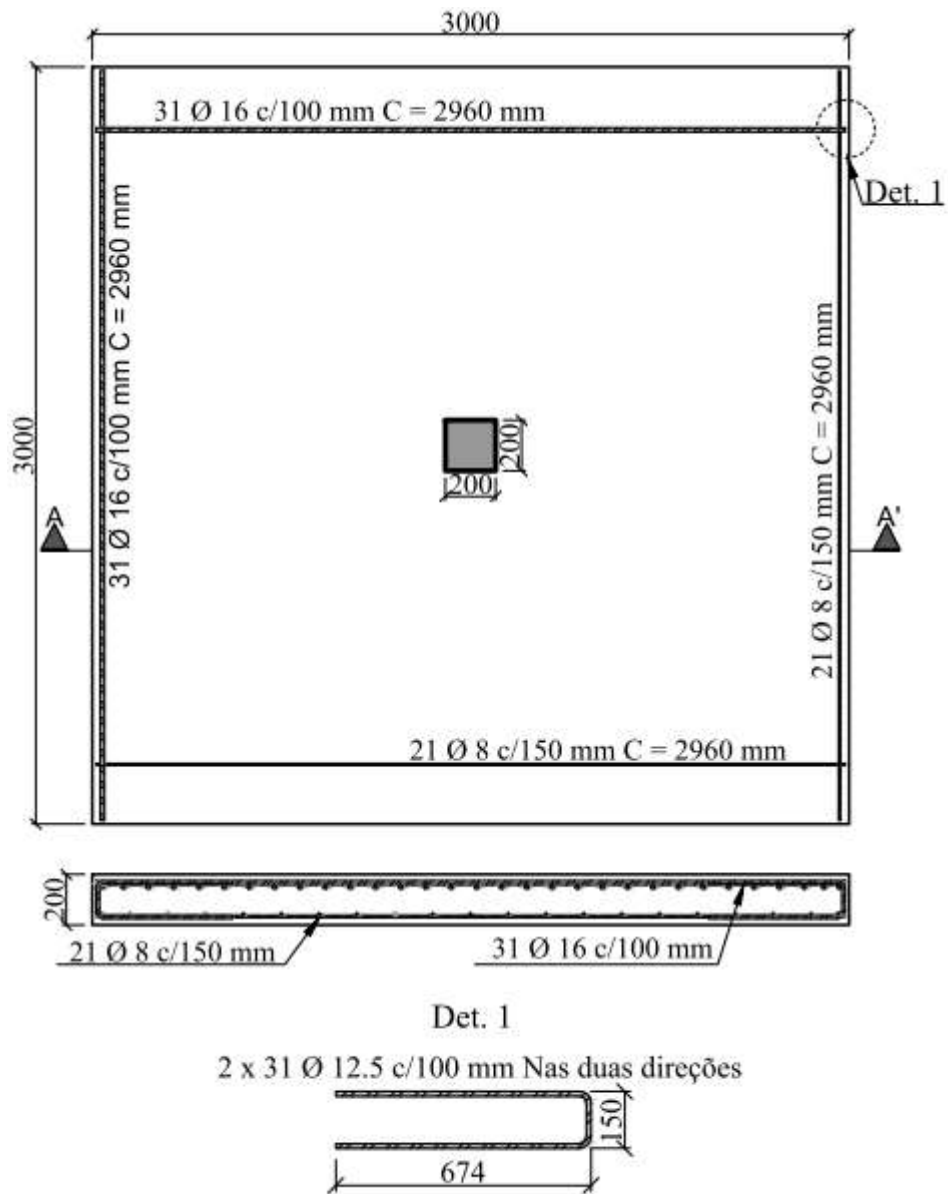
Disposição das armaduras de flexão e detalhe dos ganchos de ancoragem (TRAUTWEIN, 2001)
